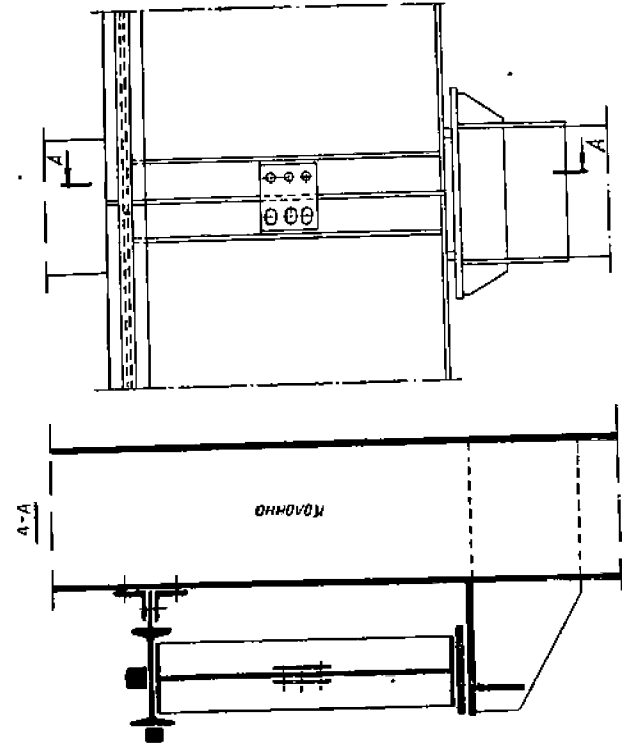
Нижняя балка подкранового пути консольного крана
